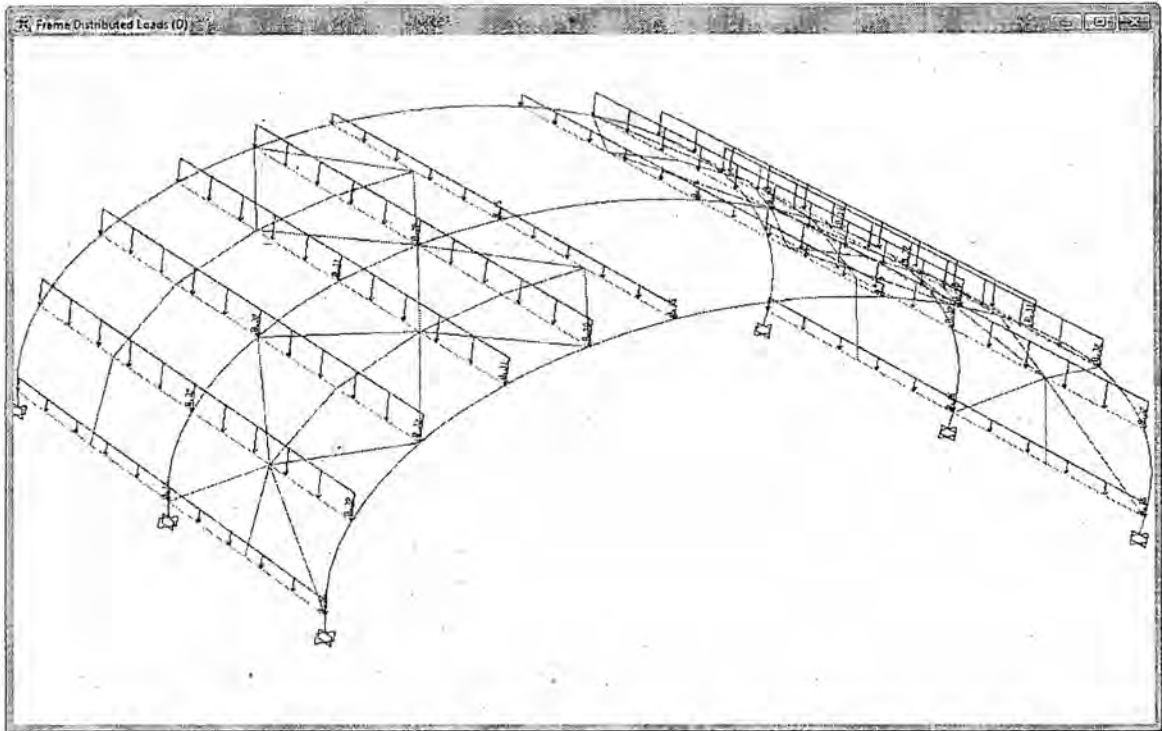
Carga de Cubiertas Metálicas y Otras Instalaciones, kg/cm (Fuente: SAP 2000)
